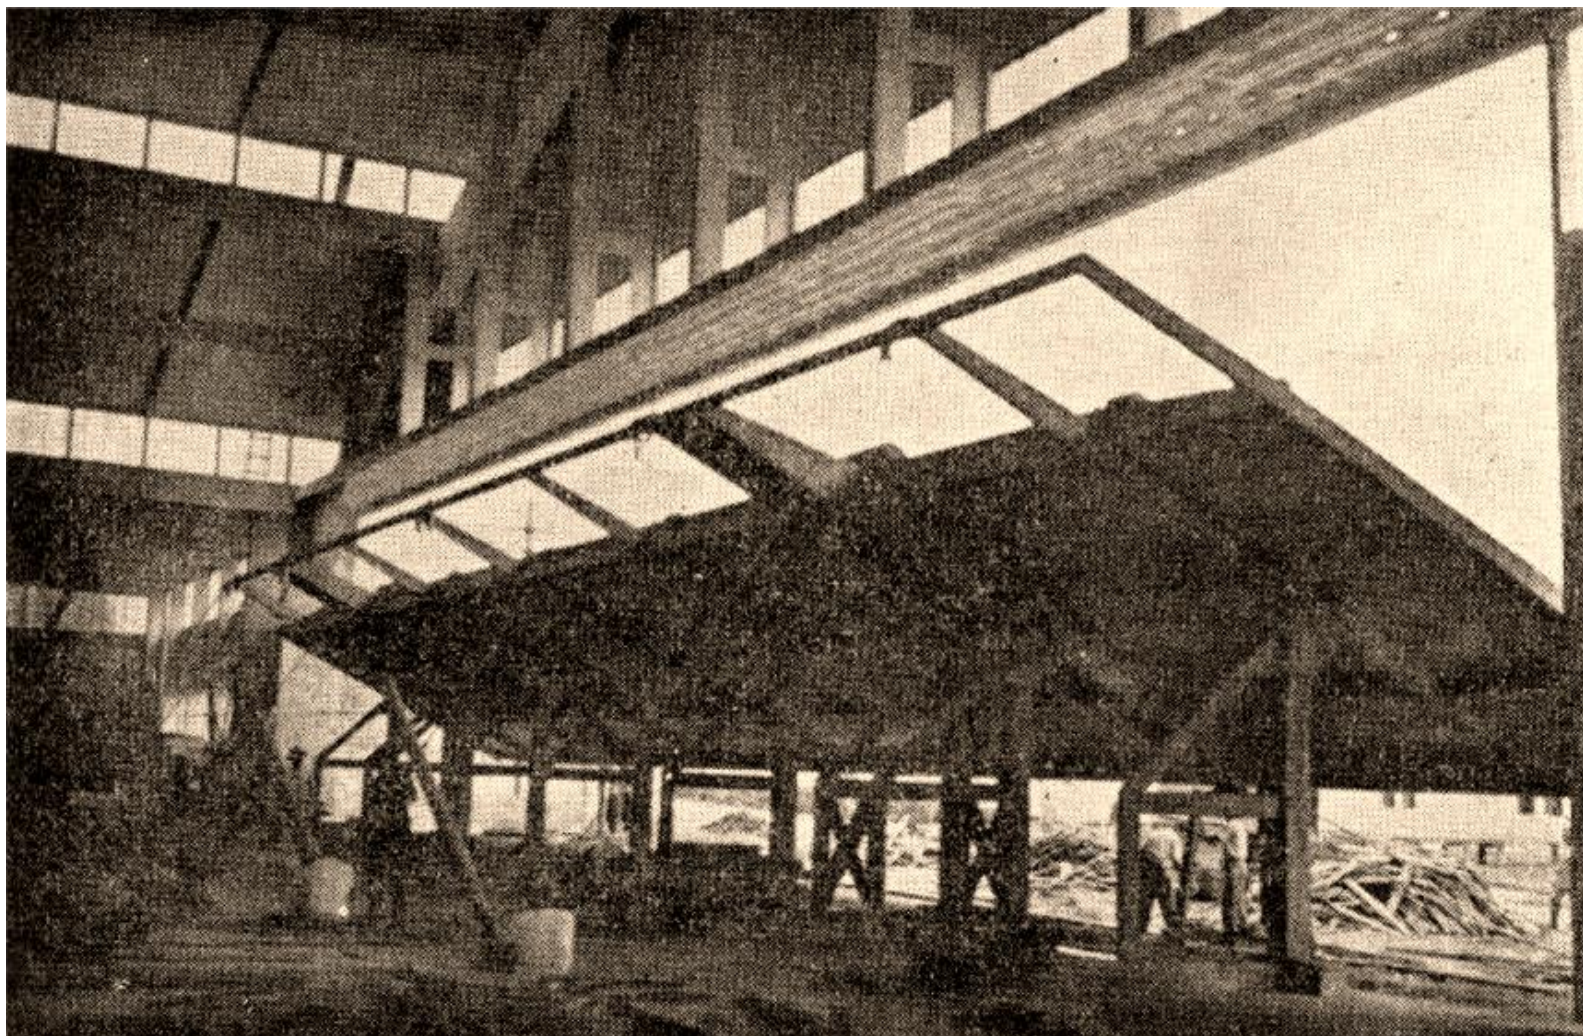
A porta de concreto armado, girando em torno de pinos embutidos em suas nervuras estruturais e apoiados em cavaletes também de concreto, vai tomando a posição vertical.
